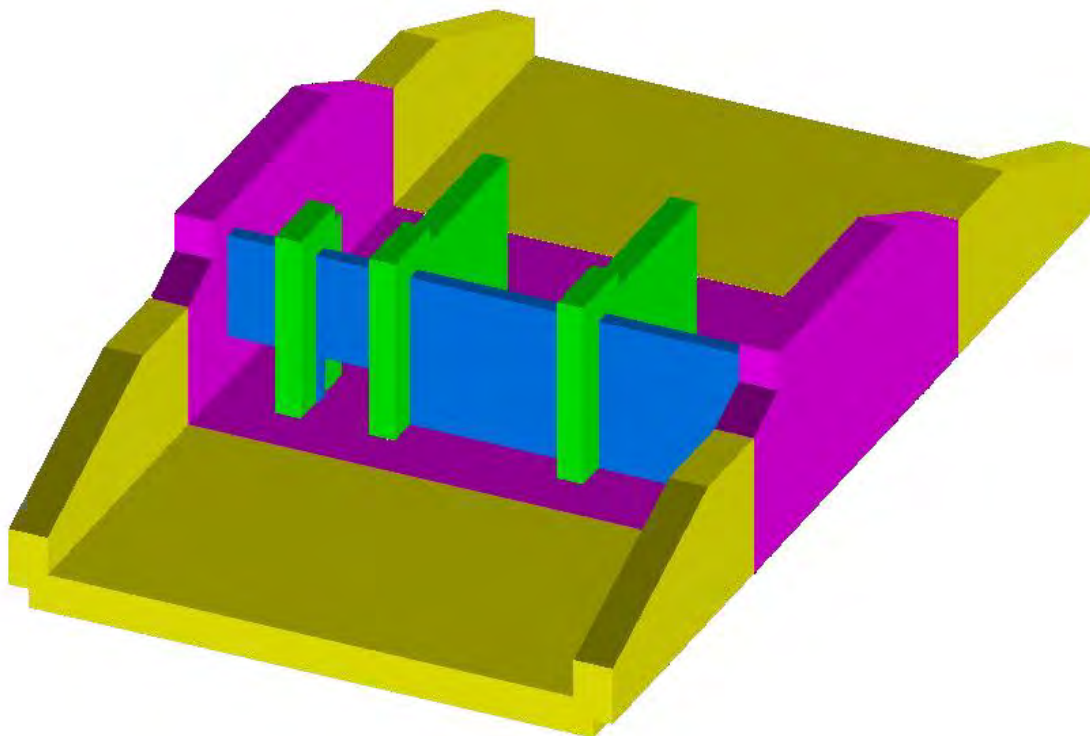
Manufatto di regolazione – vista tridimensionale
